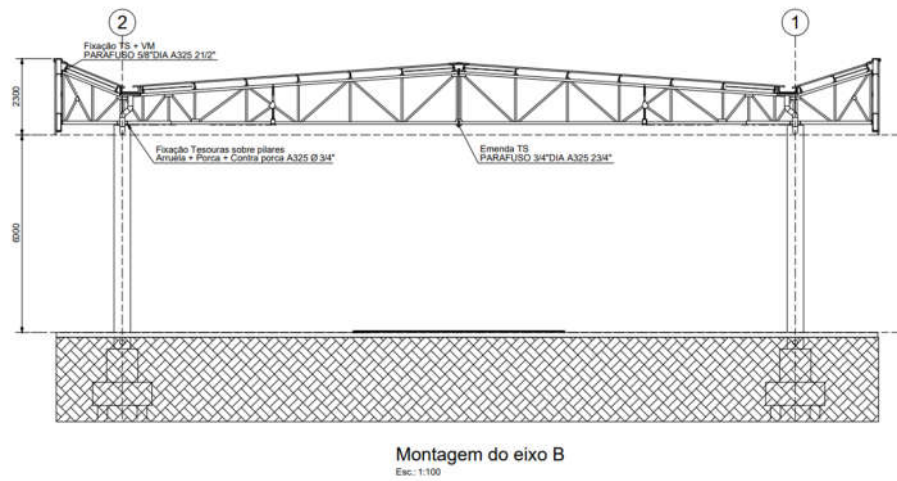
Corte Transversal da Estrutura – Geometria Real
